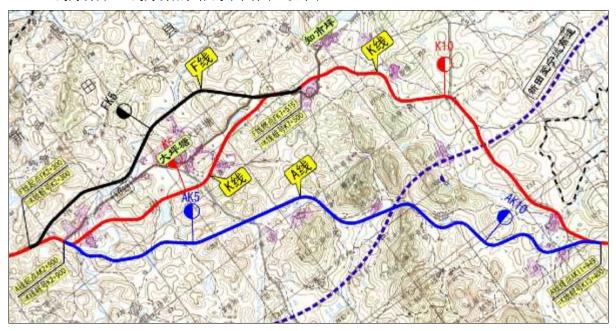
路线平面图(红色-K线,蓝色-A线)
